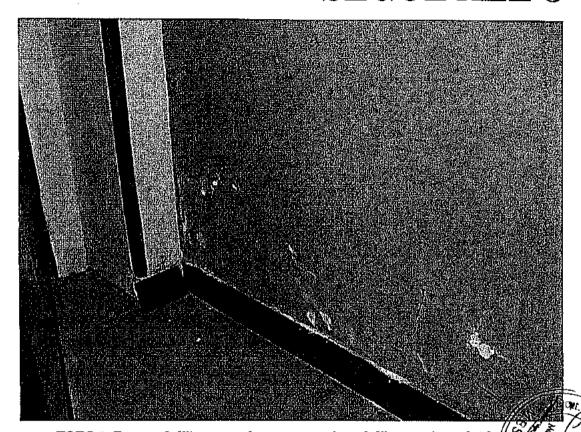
Parete dell'ingresso lato ovest prima dell'esecuzione dei la
